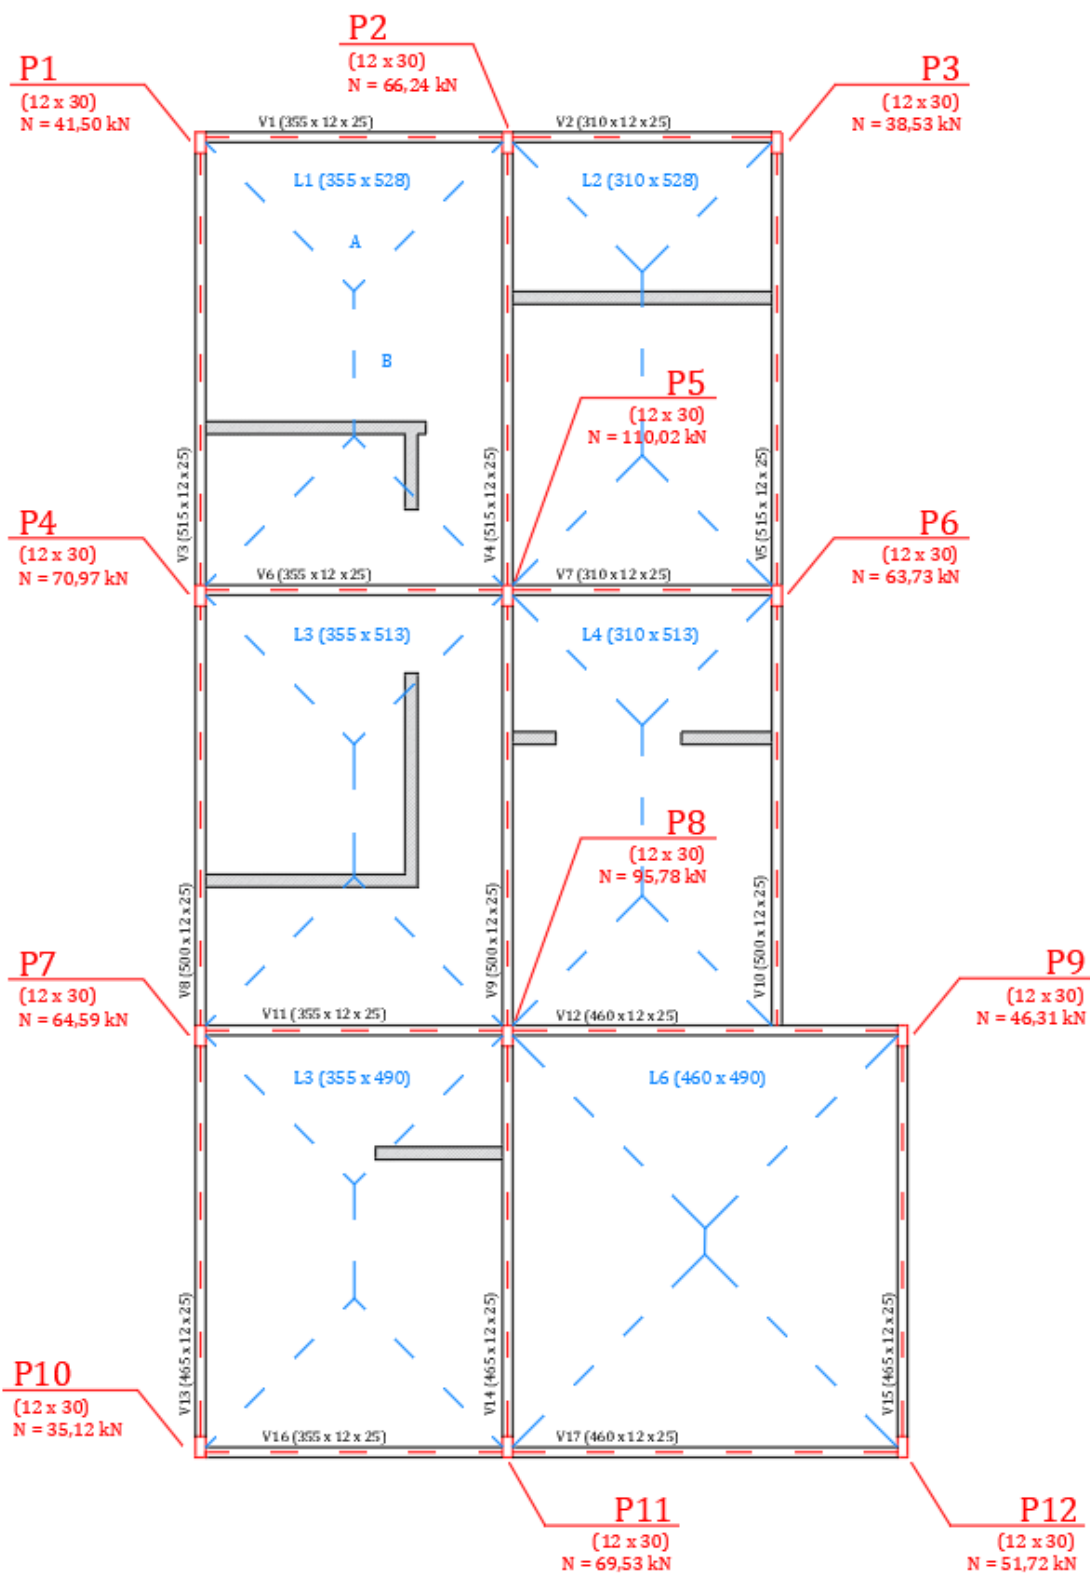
Planta de fôrma dos pilares, vigas e lajes – com indicação da carga atuante na fundação
